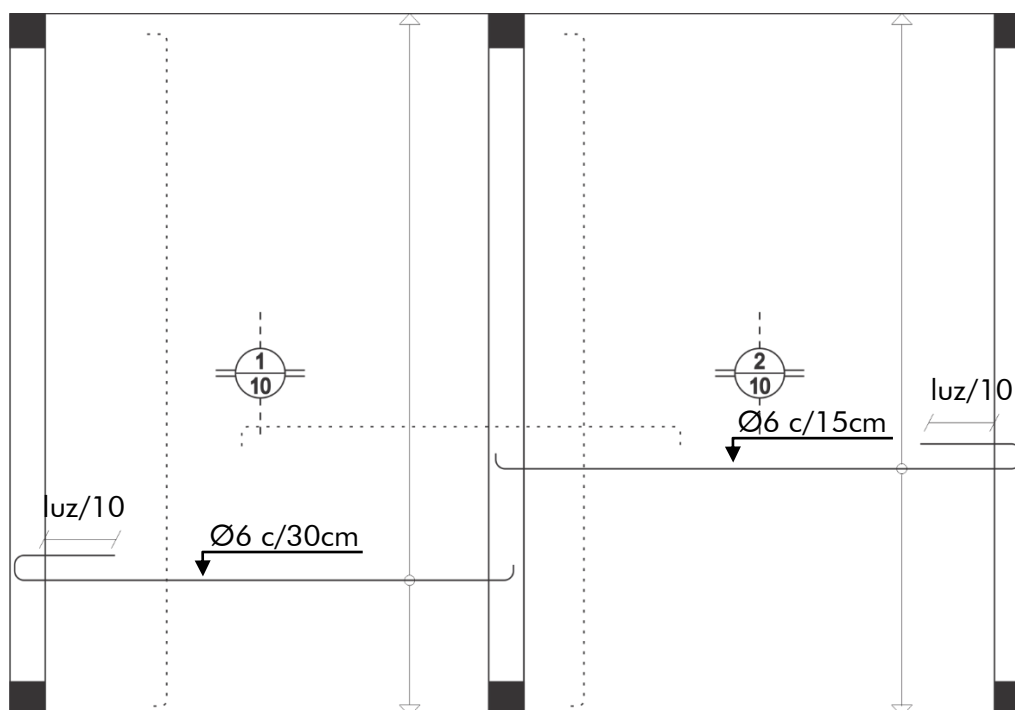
Armadura de losa en una dirección de dos tramos. En este caso se realiza el armado con una barra con separación diferente para cada tramo.
